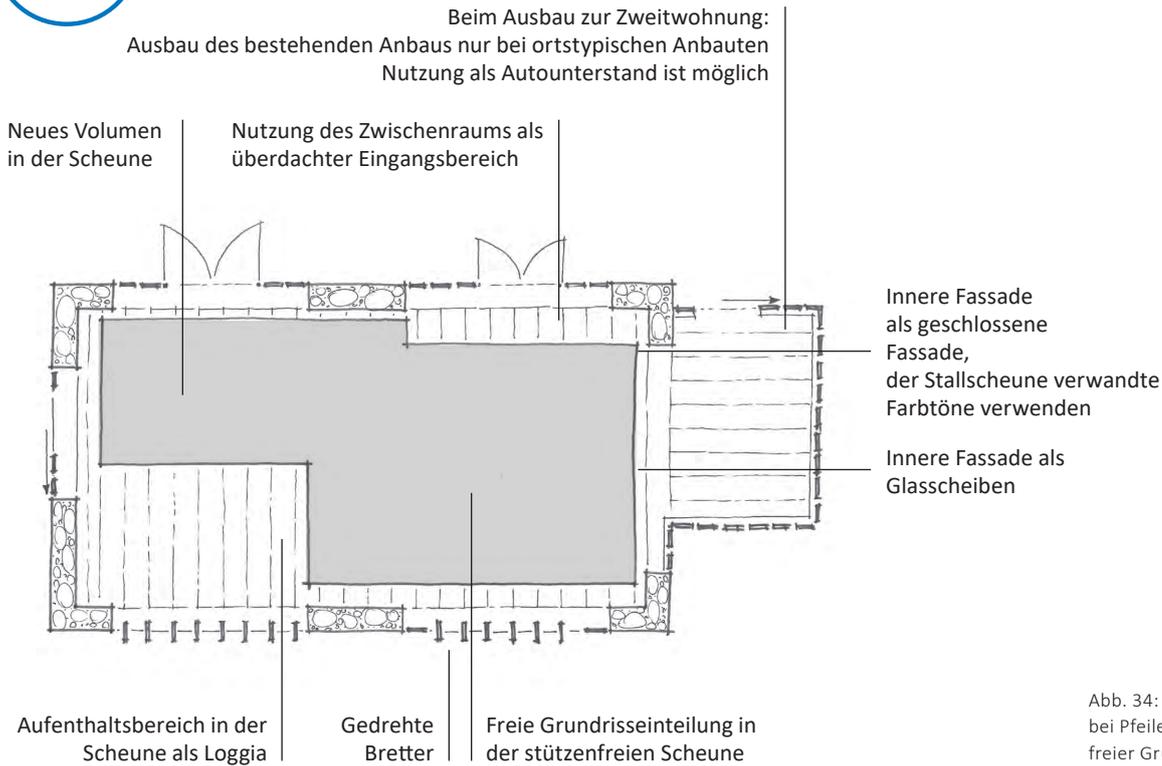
«Haus im Stall»-Prinzip bei Pfeilerstallscheunen mit freier Grundrissgestaltung.
